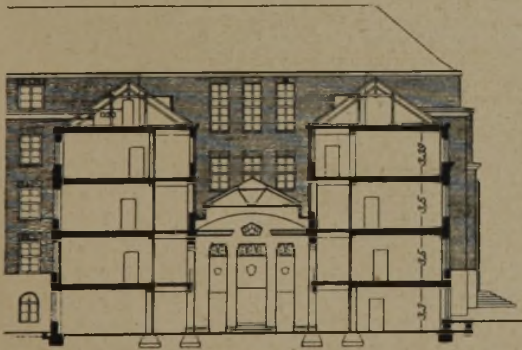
(oben). Querschnitt durch den Flügel a.d. Friedrichstraße mit Lichthof und Halle (1:500).
